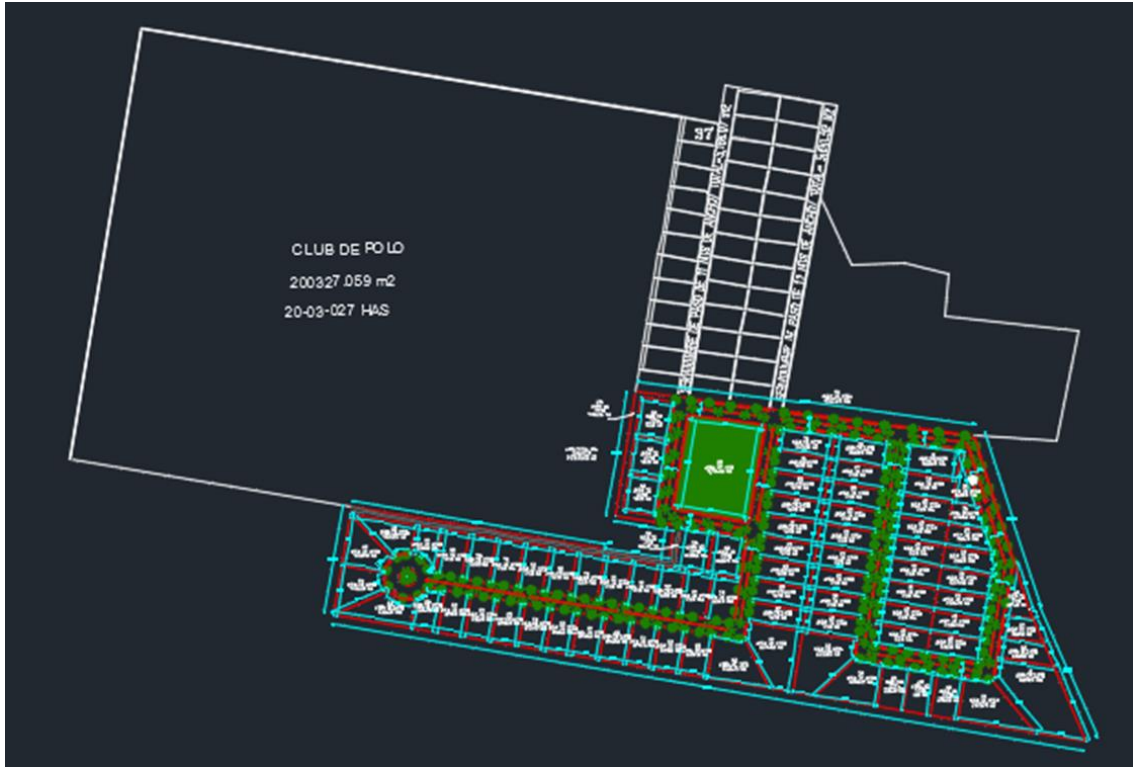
Obras del proyecto (ver plano en el anexo 1).
